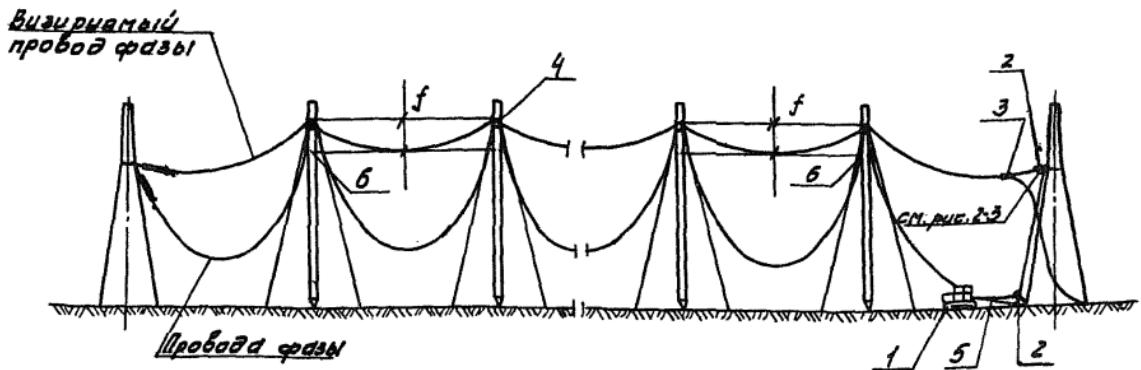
Подъем свободной натяжной гирлянды с проводом на анкерно - угловую опору.
